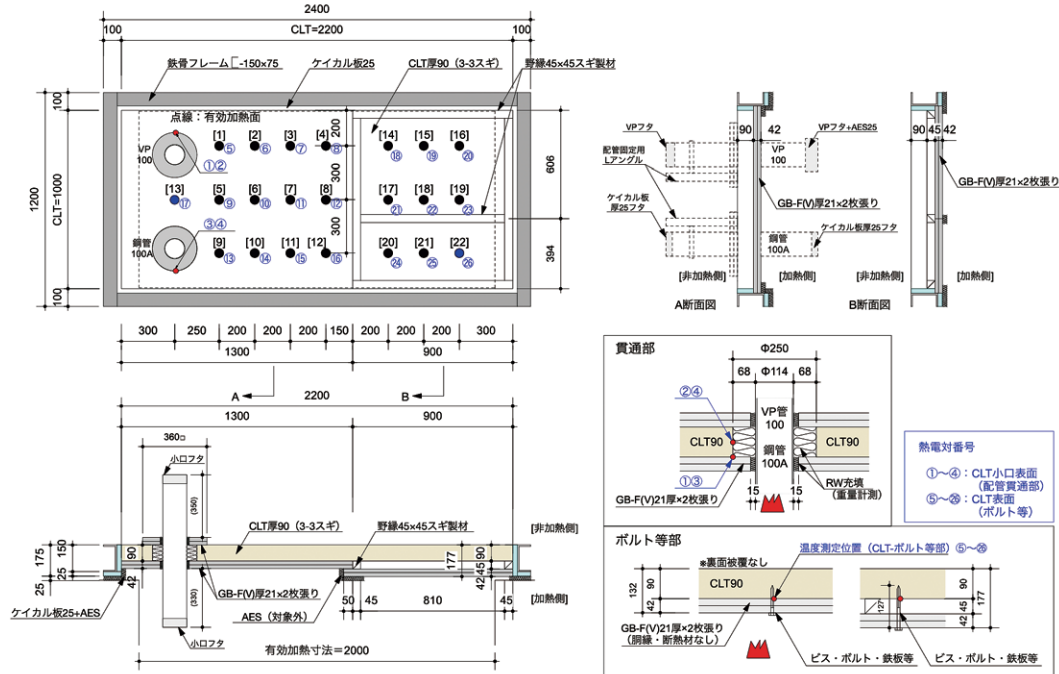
試験体②の寸法・構造・温度測定位置 (単位 mm)
